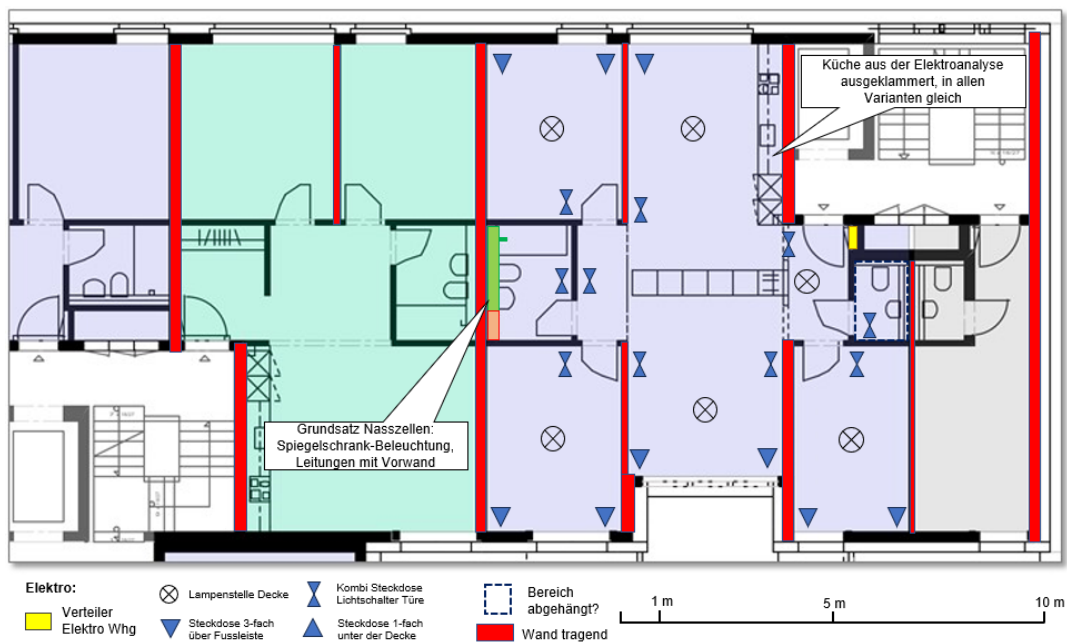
schematischer Grundriss zu den Variante 0 und 1 mit konventioneller, grundsätzlich eingelegter Elektroinstallationsausführung. Eingezeichnet sind die Lampenstellen an der Decke, Lichtschalter und Dreifach-Steckdosen in den Räumen (i.d.R. 20 cm über dem Boden).
